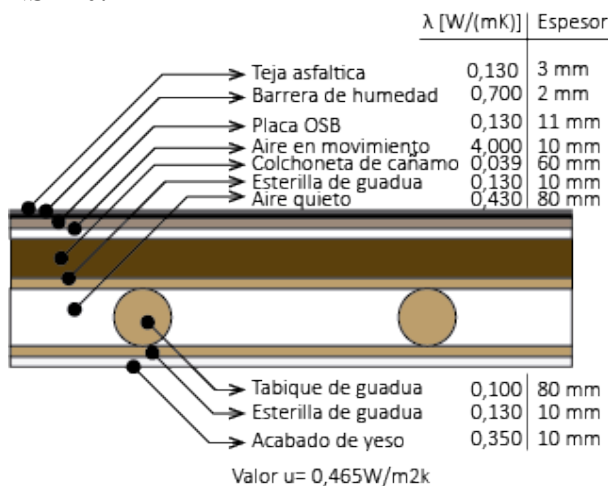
Sistema constructivo de techo. Fuente: elaboración propia.
